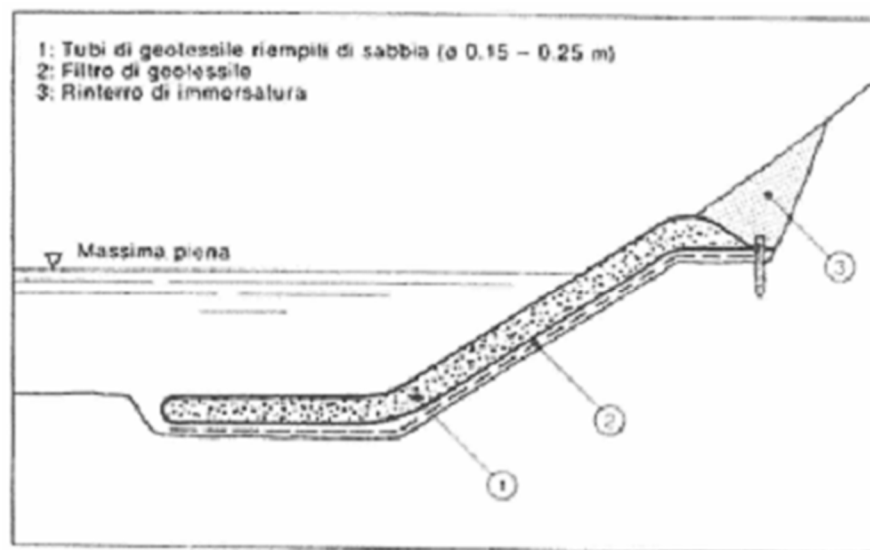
Tipico esempio di protezione delle sponde<sup>11</sup>
